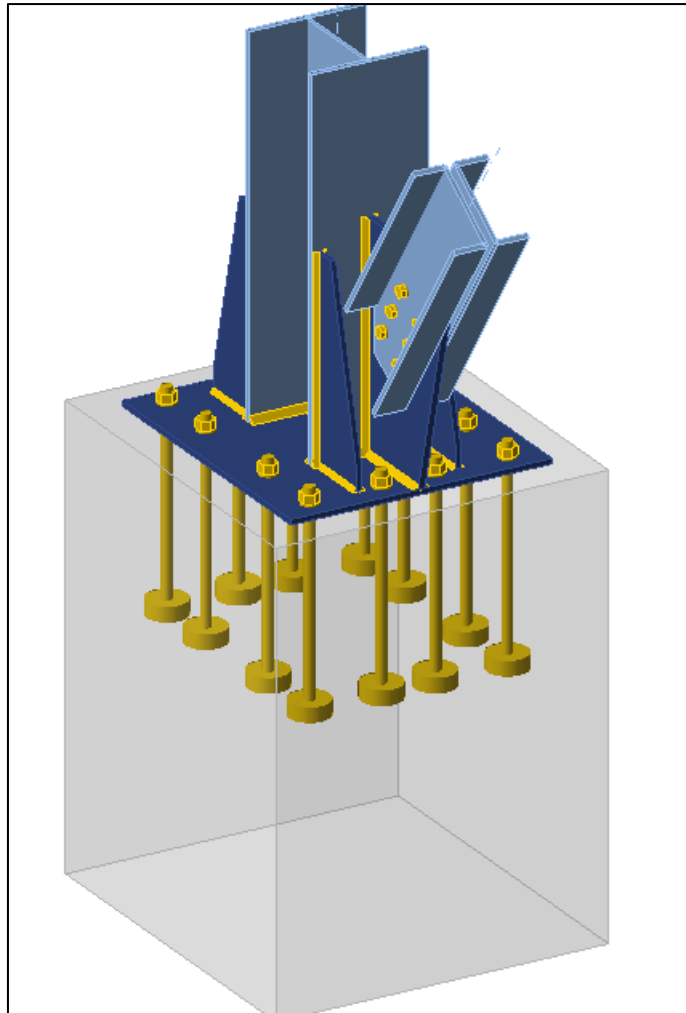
Vue d'assemblage pied de poteau HEB260-double UPN200.
